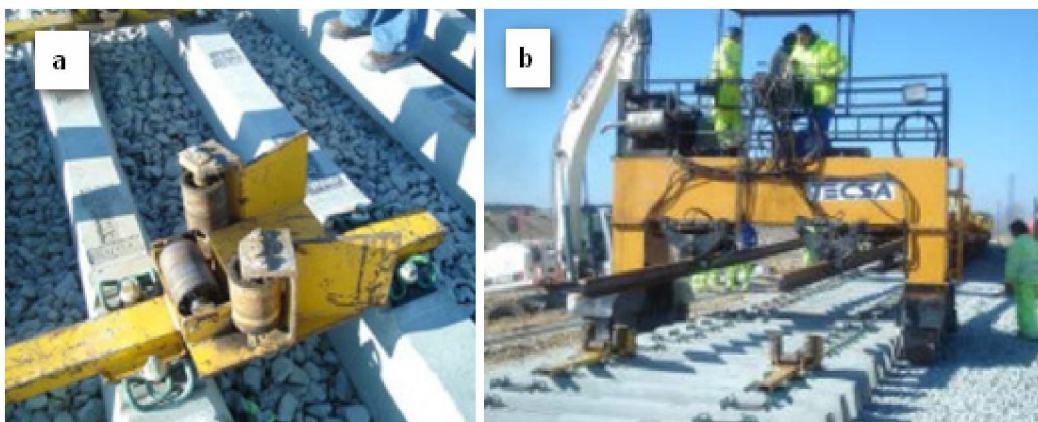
a) Corrons per al lliscament dels carrils sobre les travesses. b) Descàrrega dels carrils amb grua des del tren carriler, extret de [9].
